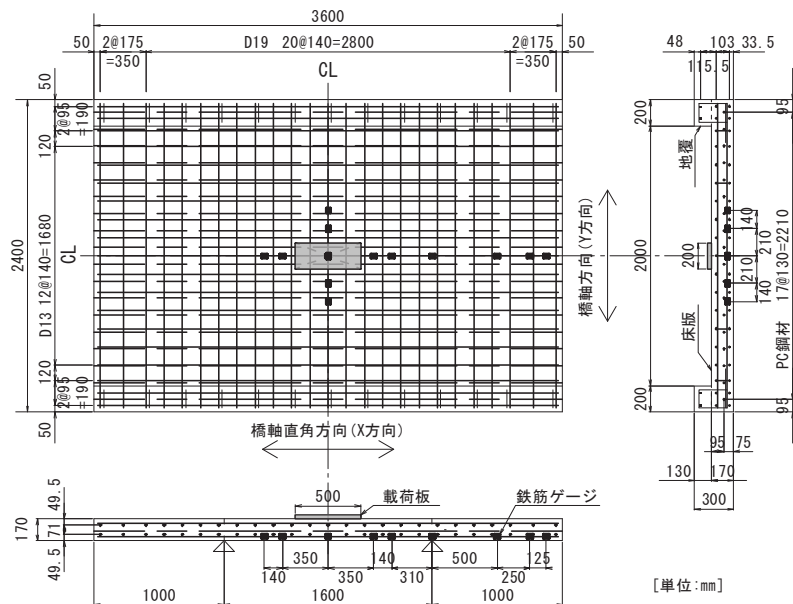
試験体寸法およびPC鋼材と鉄筋の配置
